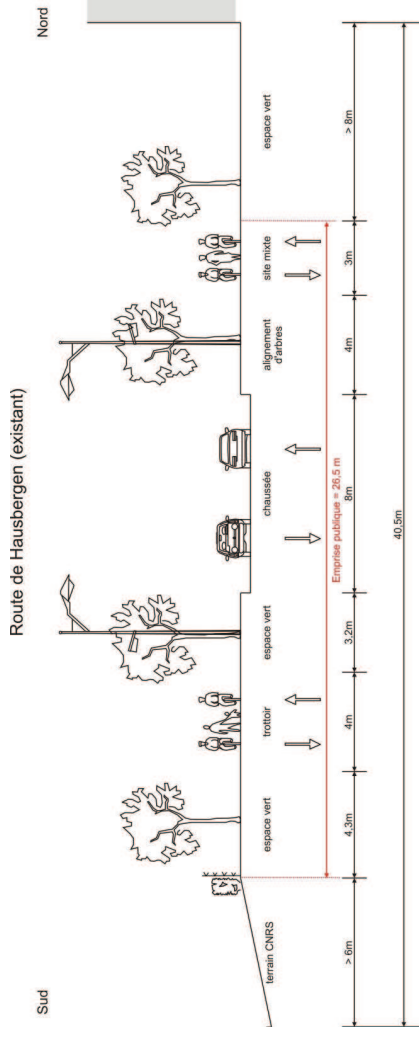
Situation existante (coupe 17) sur la route de Hausbergen
